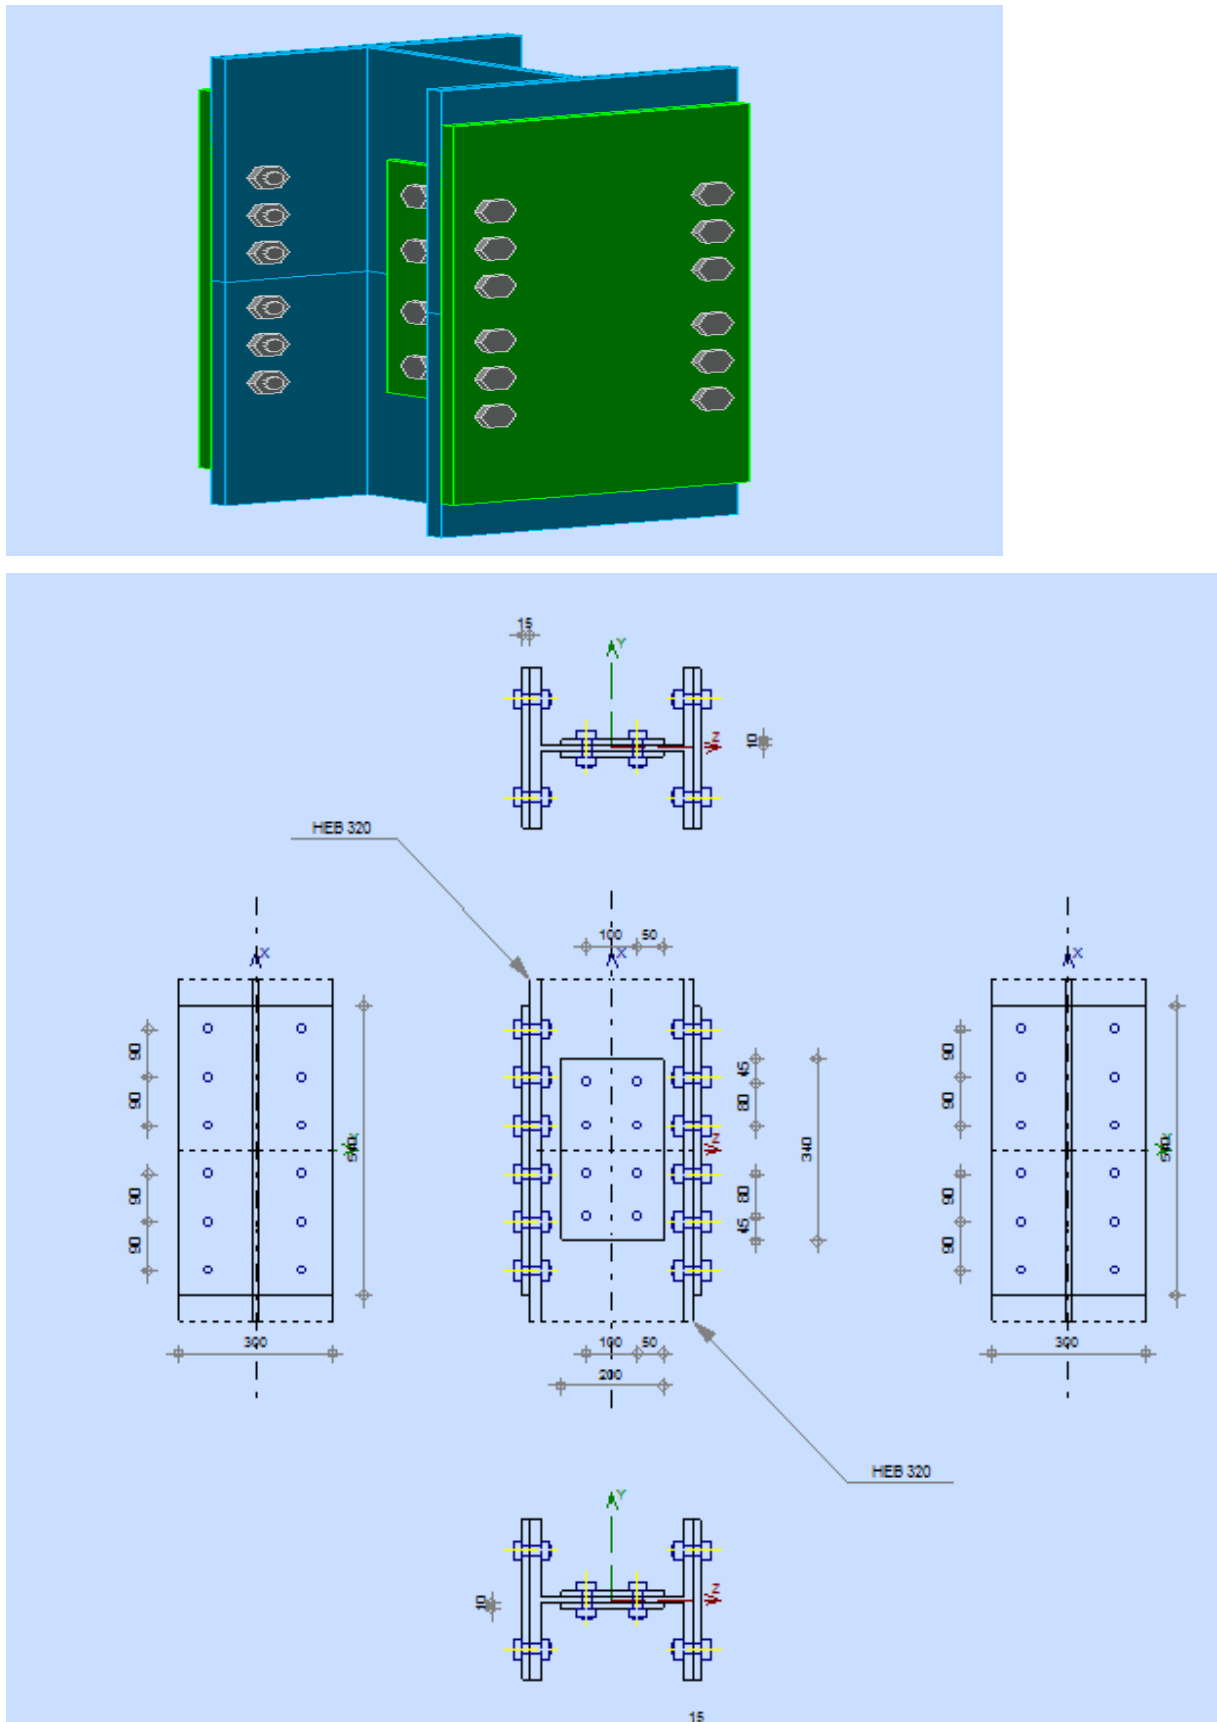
assemblage poteau –poteau (HEB320-HEB320)
